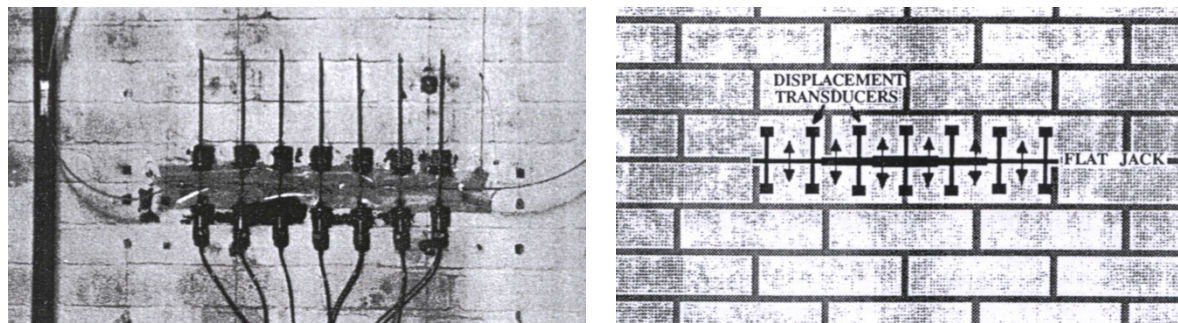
Configurazione della prova con martinetto singolo in laboratorio. (Abram et al., 1989)
